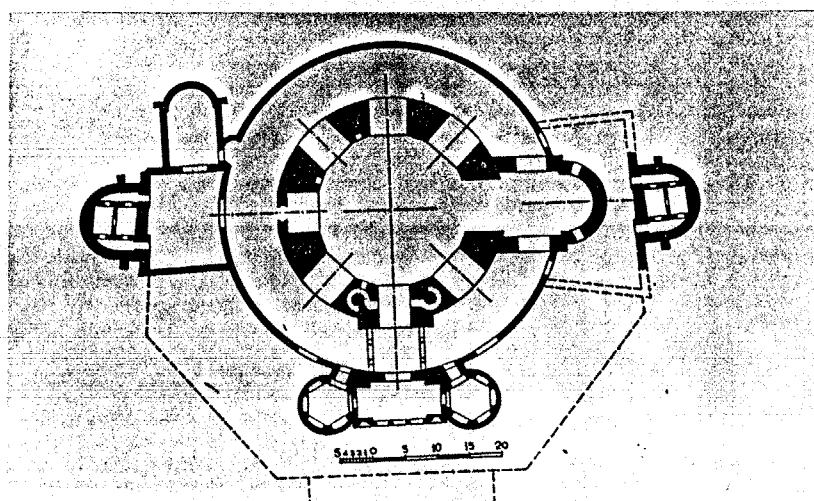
： テサロニキのロトンダ・教会堂時期平面図 (after Pazara)
